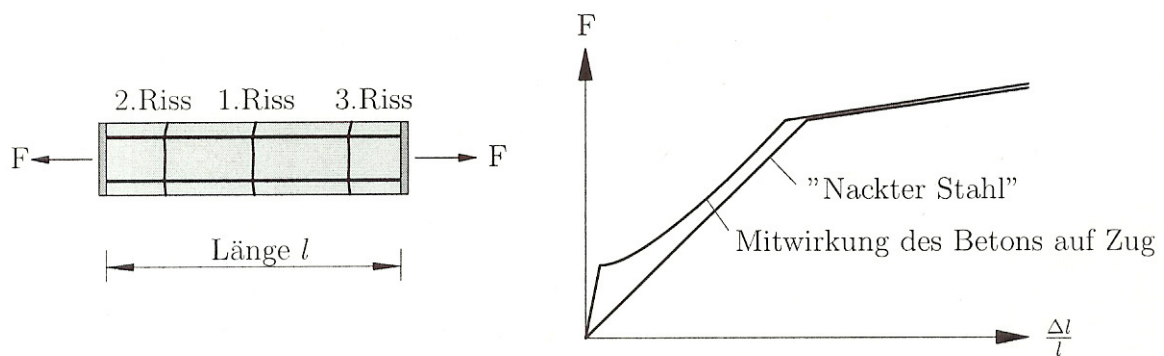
B.14 Tension-stiffening bei einem Stahlbetonzugstab
